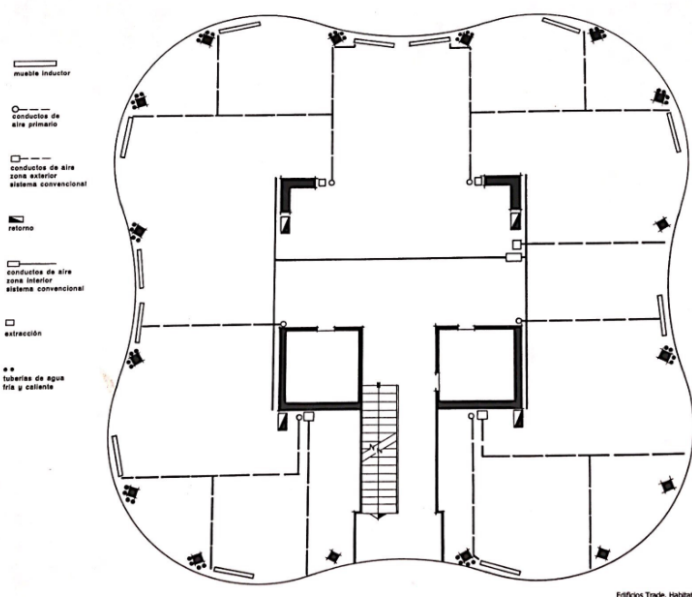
Planta de instalaciones. Fuente: Corbetta y Parés, 2005.
